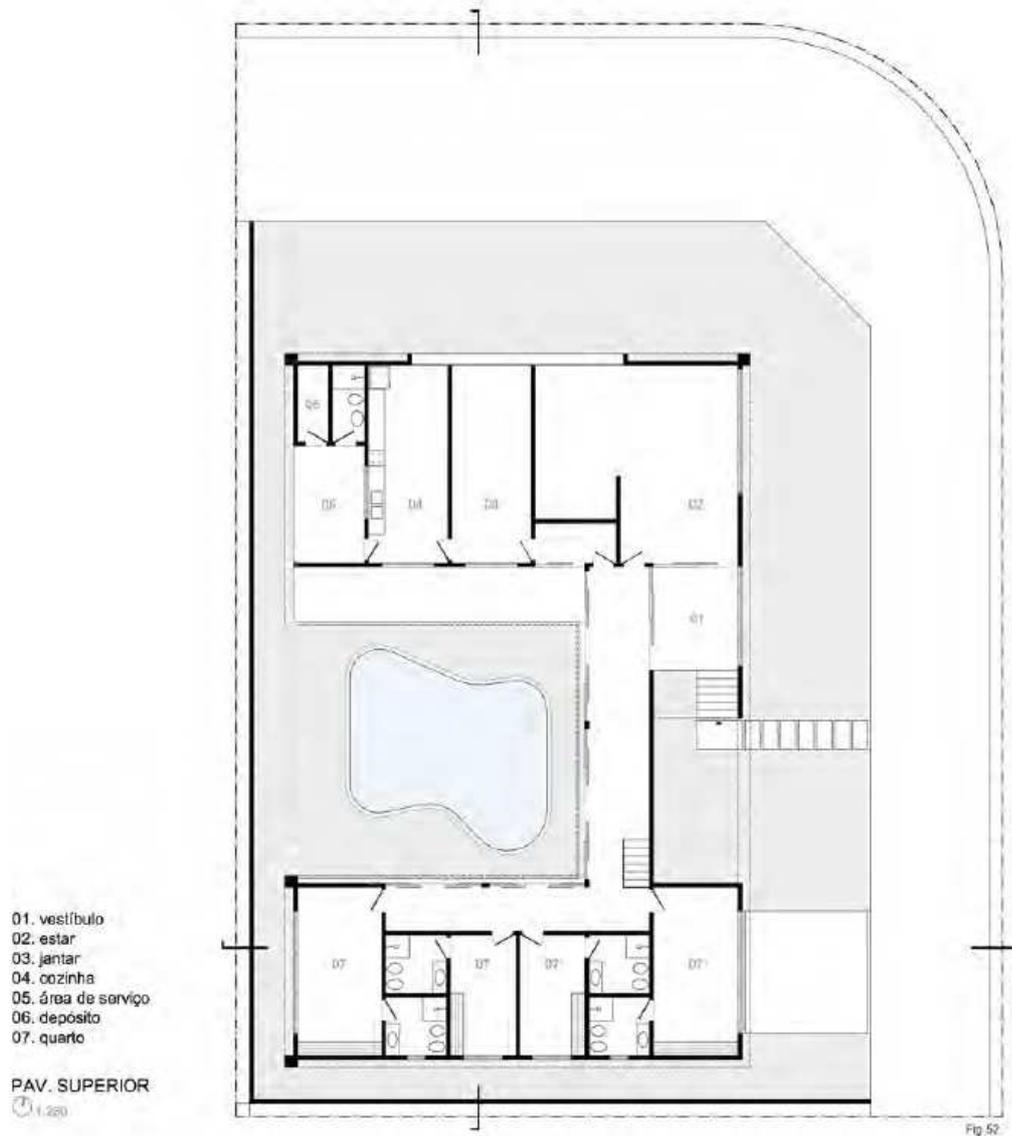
| PLANTA BAIXA CASA JOSÉ RIBEIRO PARRODE, 1960, SETOR OESTE, ARQUITETO EURICO DE GODOY. SILVA NETO, 2010, P. 78.
